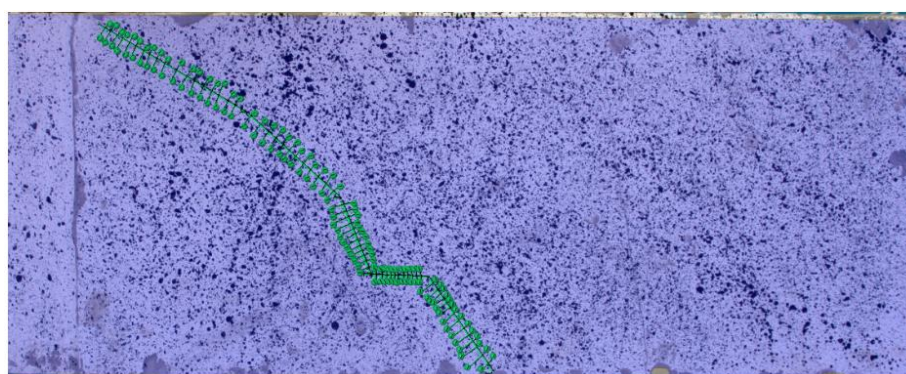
Formato esquemático simplificado da fissura diagonal de cisalhamento das vigas reforçadas com compósitos de fibras em duas direções (FM).
